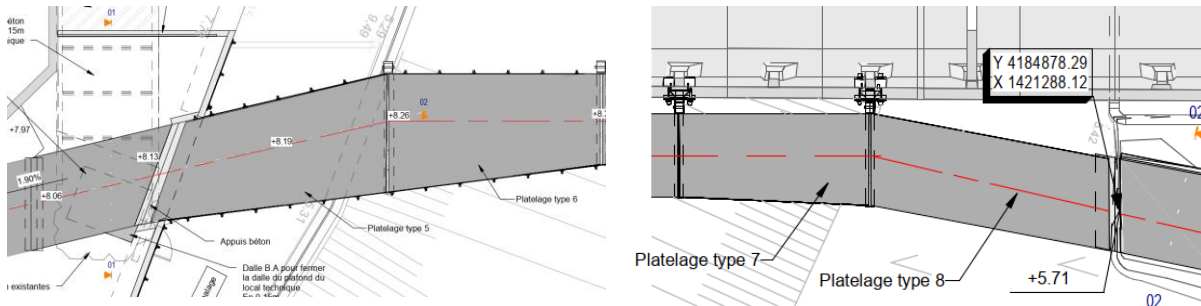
Extrait cahier de plan – Vue en plan platelage d'extrémités (rive gauche et rive droite)
